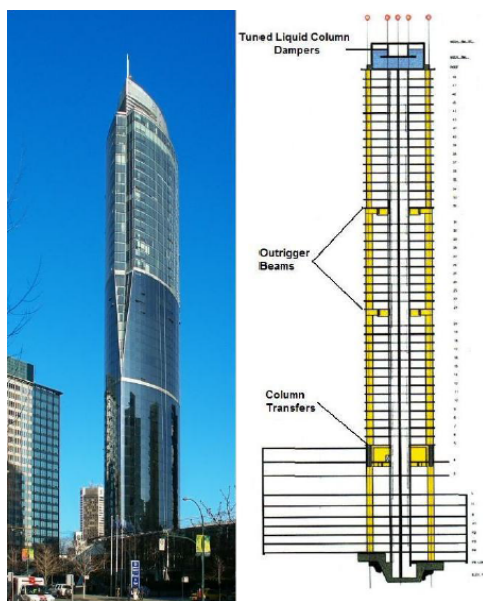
En la figura¹ se muestra el edificio One Wall Centre, el sistema estructural y la ubicación del TLCD.
